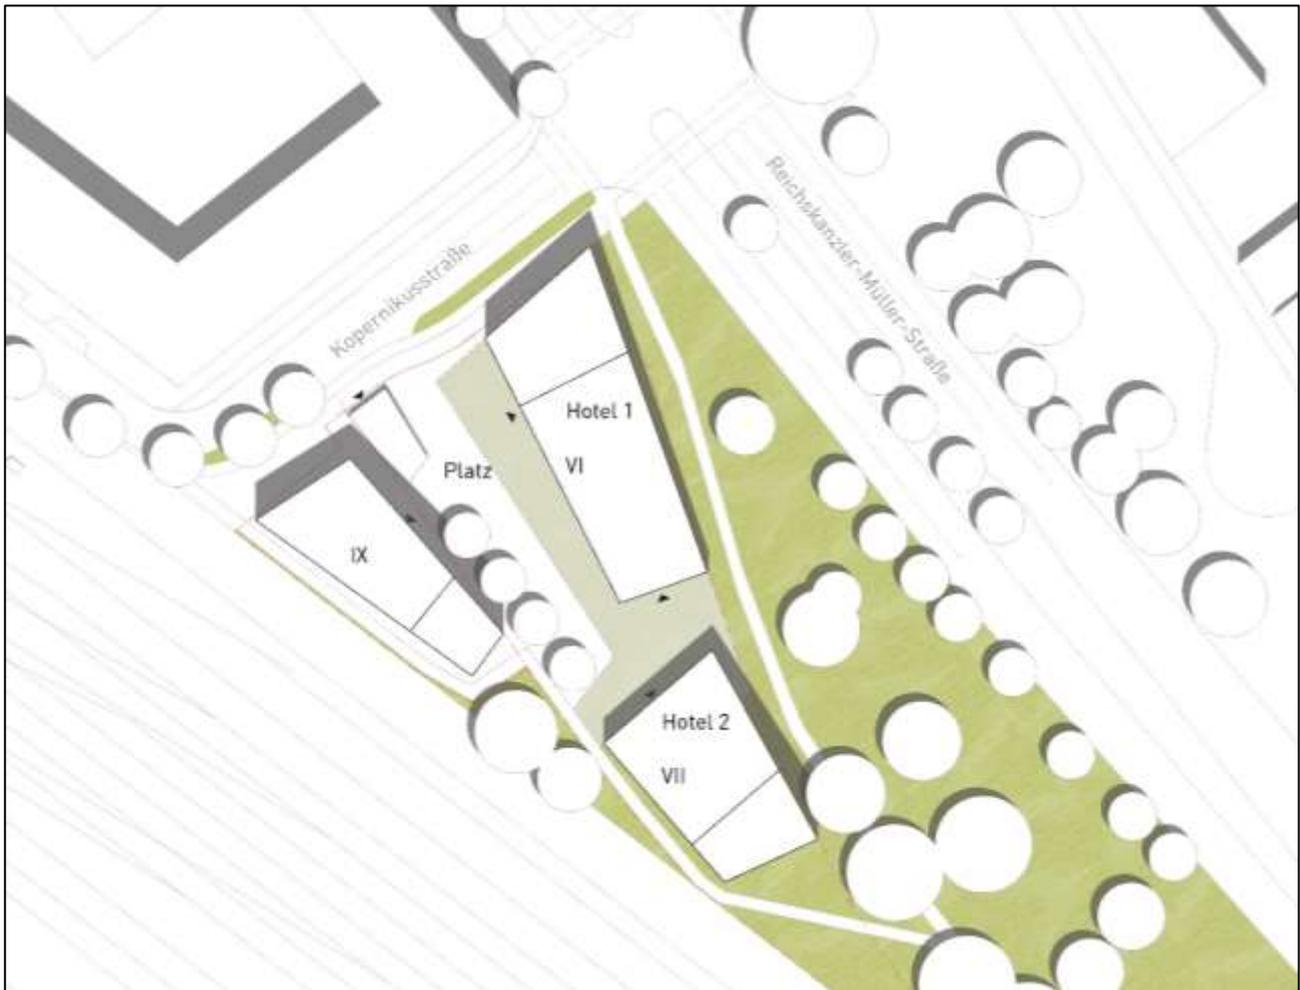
Wettbewerbsentwurf – Lageplan (nicht maßstäblich)
